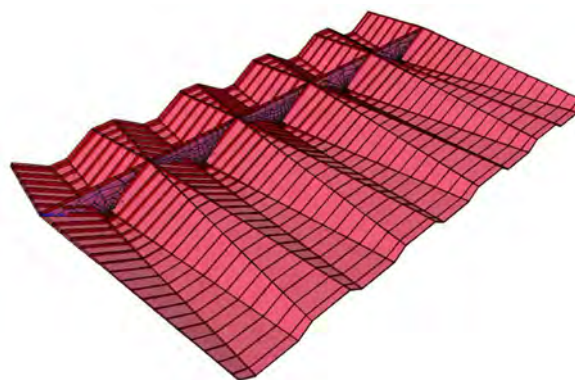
Modelo de la lámina plegada de hormigón de la cubierta del canódromo, en SAP2000.
